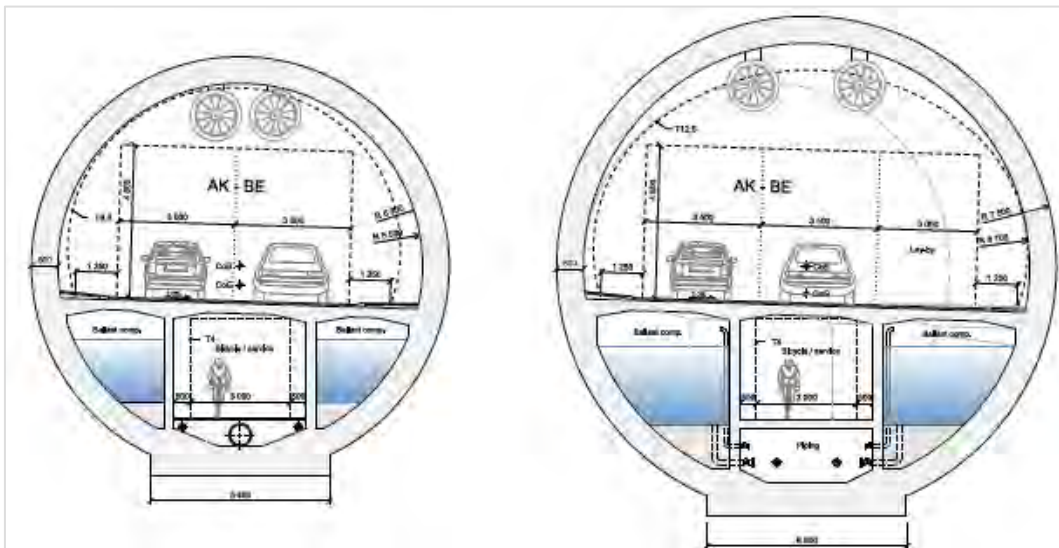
Tunnel sommerso progetto Bjornafjord 2016 – Sezione tunnel stradale (Fonte Statens vegvesen)
